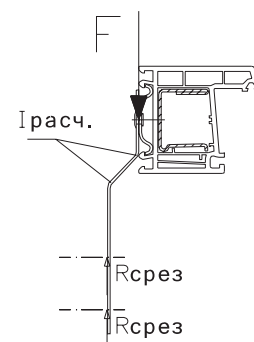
Статическая схема передачи расчётных усилий на стену здания.
